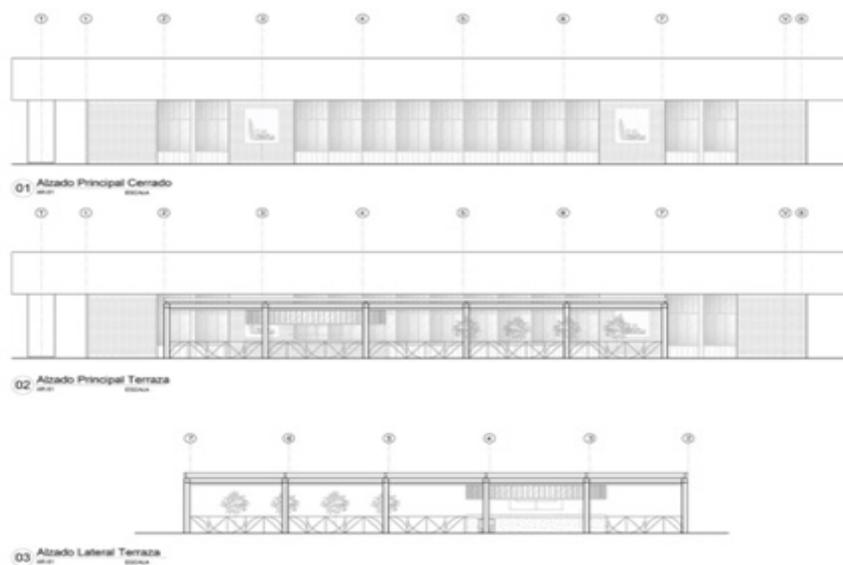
Cortes fuente:<http://www.archdaily.mx/mx/880321/restaurante-la-tequila-leon-inaki-diaz-de-leon-orraca>, fecha: [06-10-2017]
